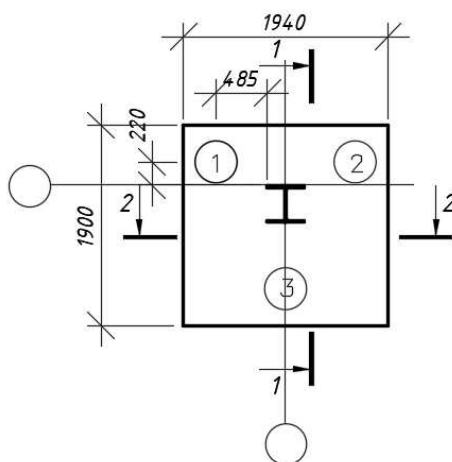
Схема к расчету ростверка на изгиб
